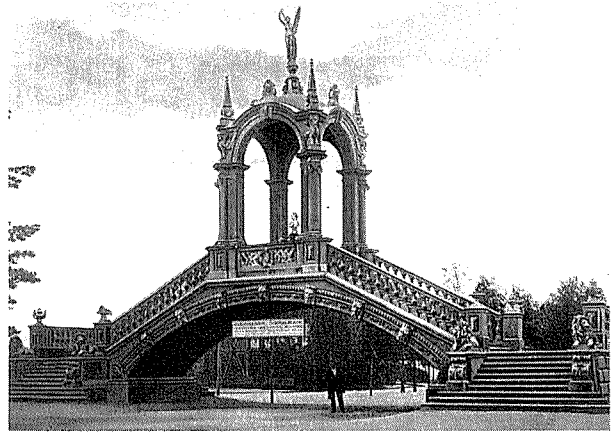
ドイツのコンクリート製歩道橋 (1880年)
